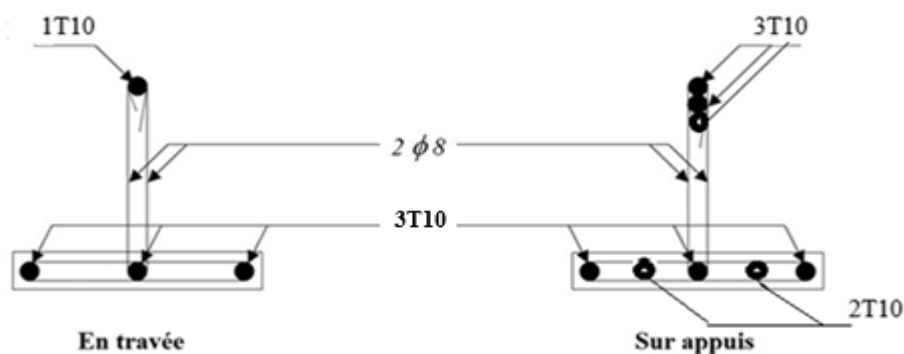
Schéma de ferrailage des poutrelles en travée et appuis.
